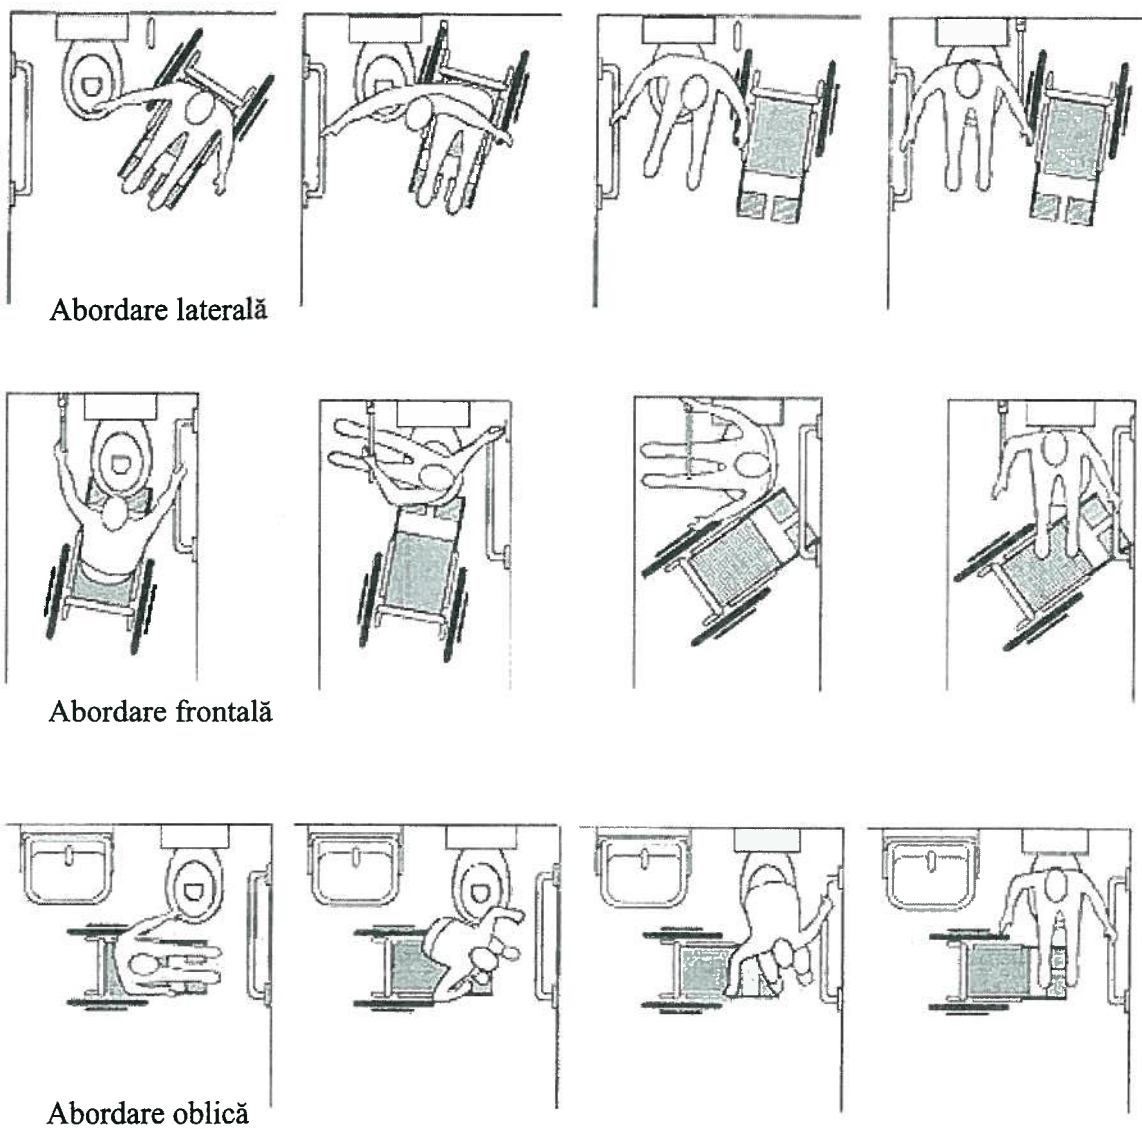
Transferul din fotoliu rulant prin abordare laterală, frontală, oblică
